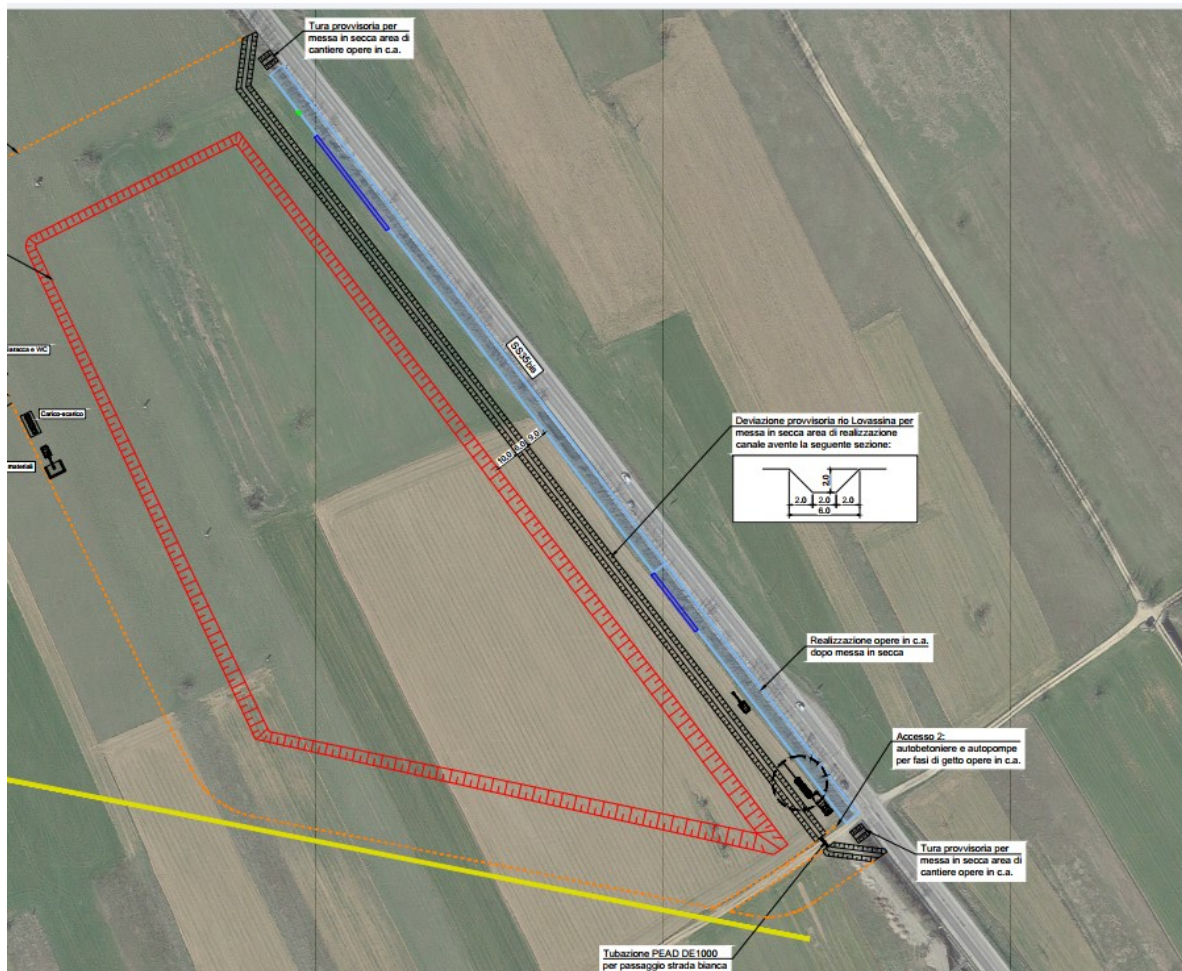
Estratto Tav. 03.1_Planimetria cantiere Fase 1
